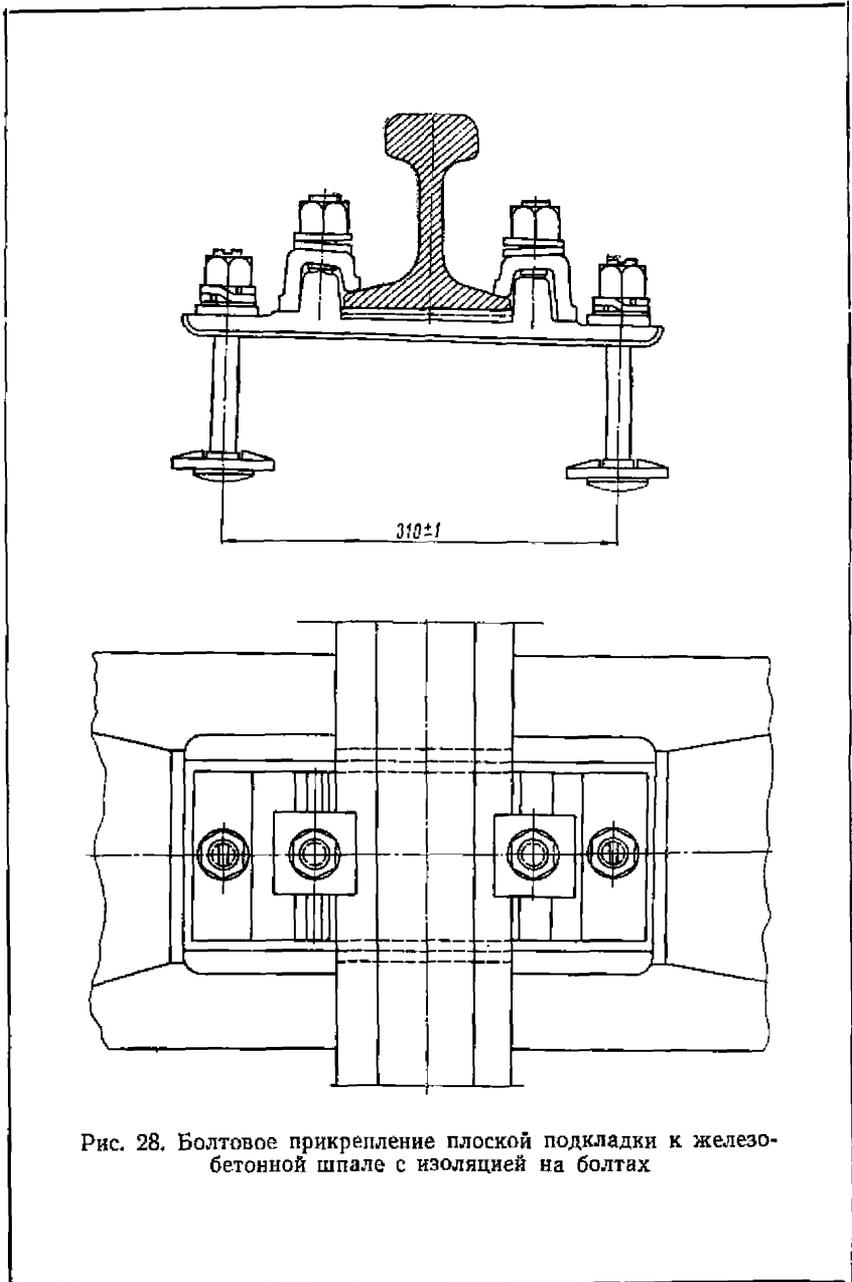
Болтовое прикреплeние плоской подкладки к железобетонной шпале с изоляцией на болтах
